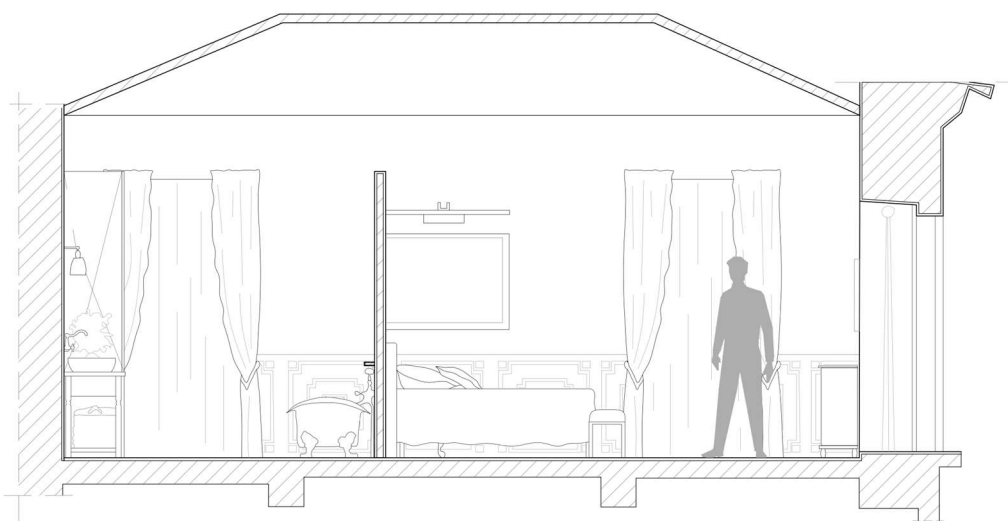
Corte FF' Fonte: Bruna Monteiro
